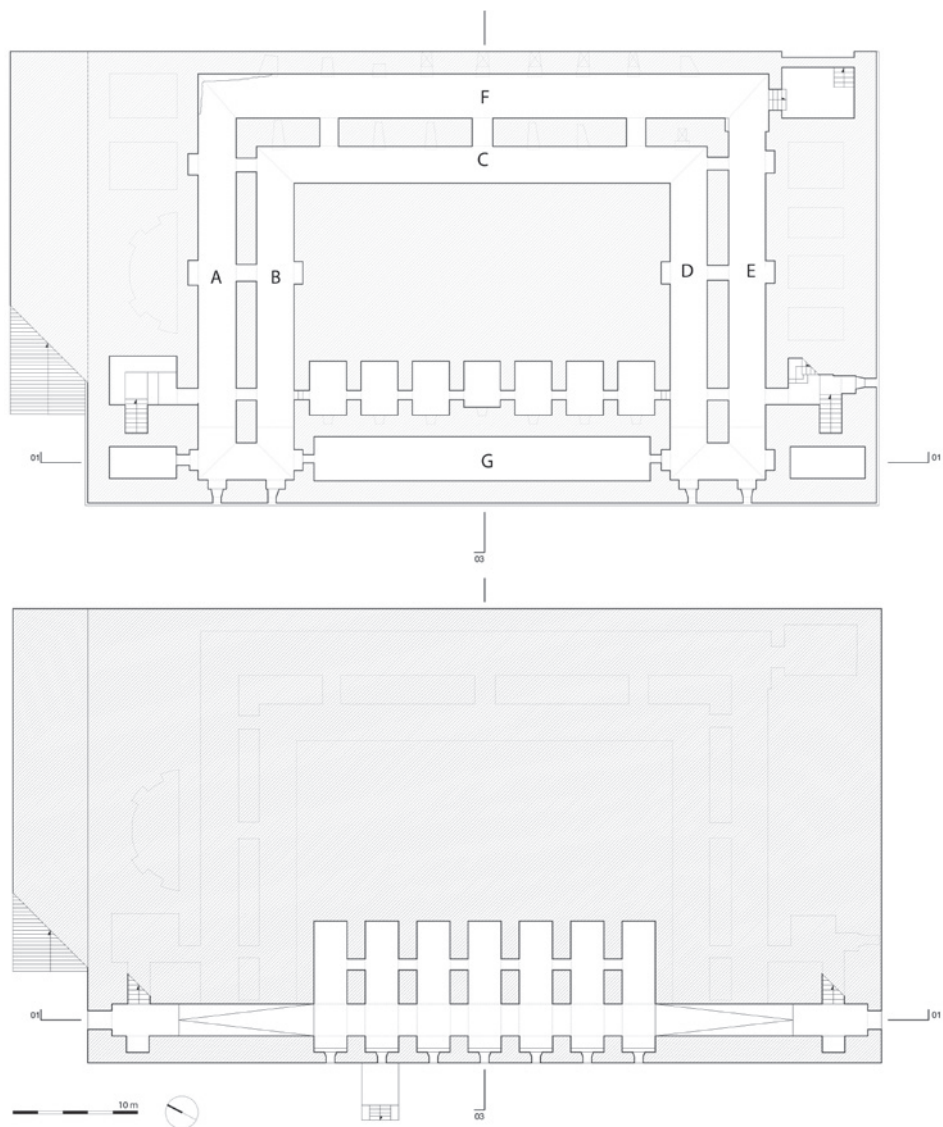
Em cima, planta do piso superior do criptopórtico (com galerias numeradas). Em baixo, planta do piso inferior do criptopórtico.
